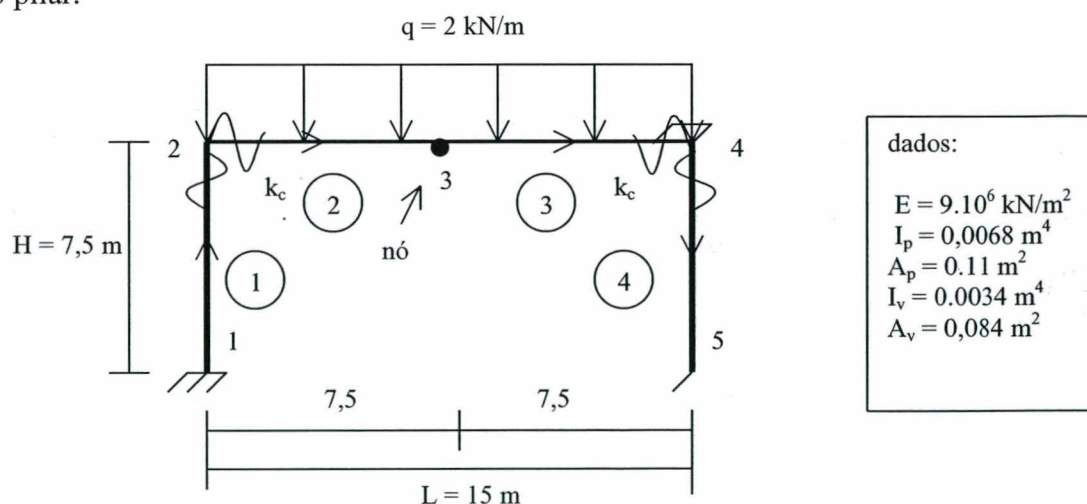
Pórtico plano com carregamento uniformemente distribuído com conexões semi-rígidas.
